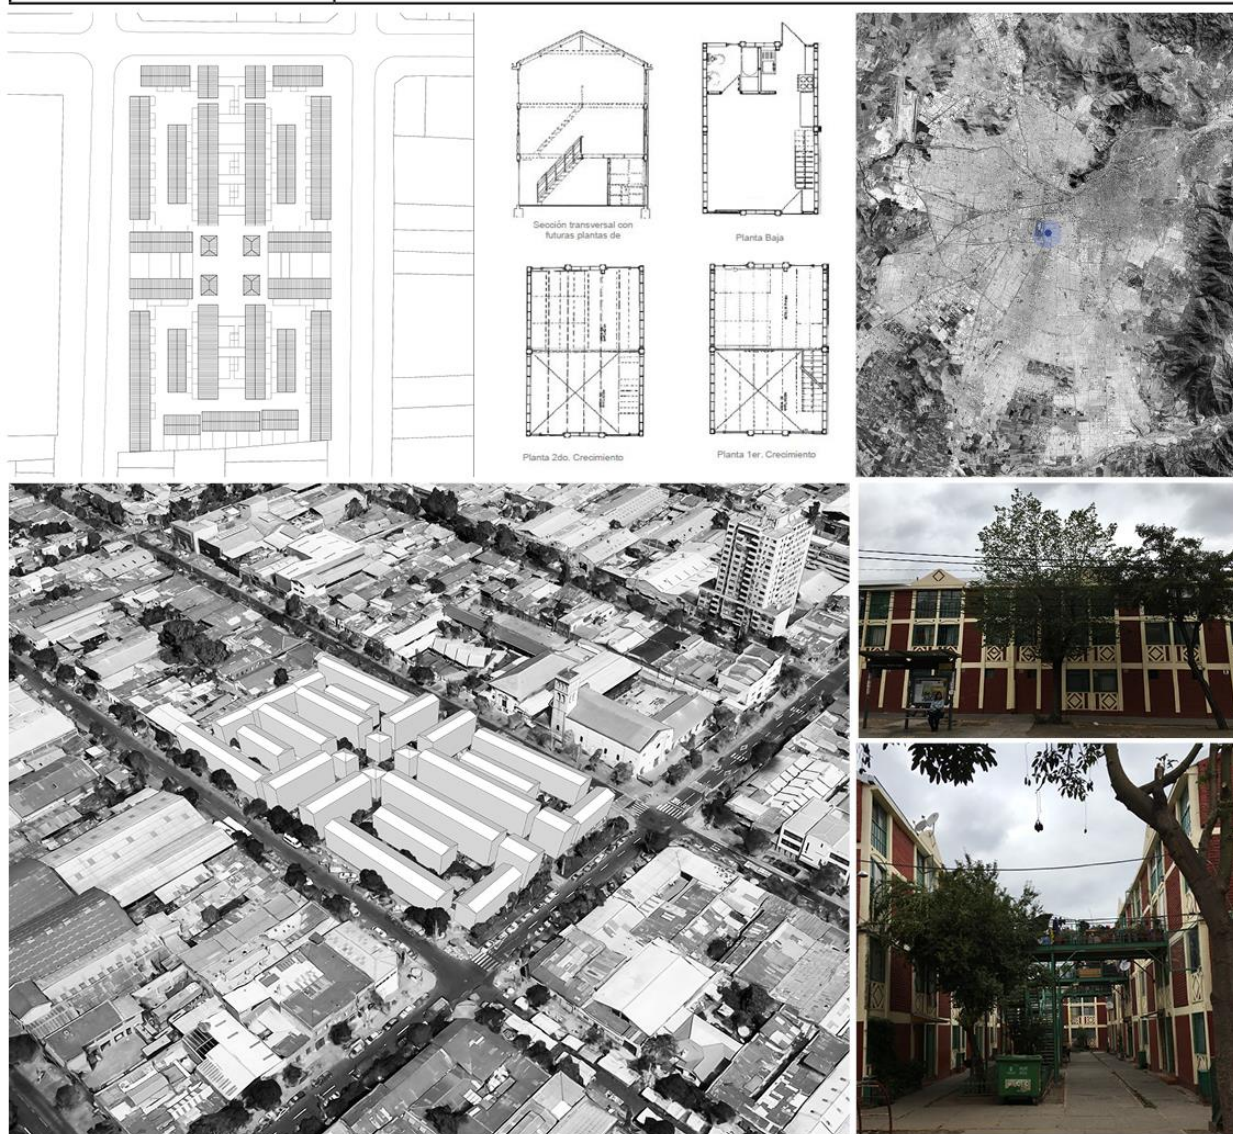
ficha Comunidad Andalucía. / Planta conjunto, plano ubicación y vista aérea: elaboración propia. / Imágenes 1 y 2: archivo de la autora (2019) / Planimetría vivienda: gentileza arquitecto Eduardo San Martín.
